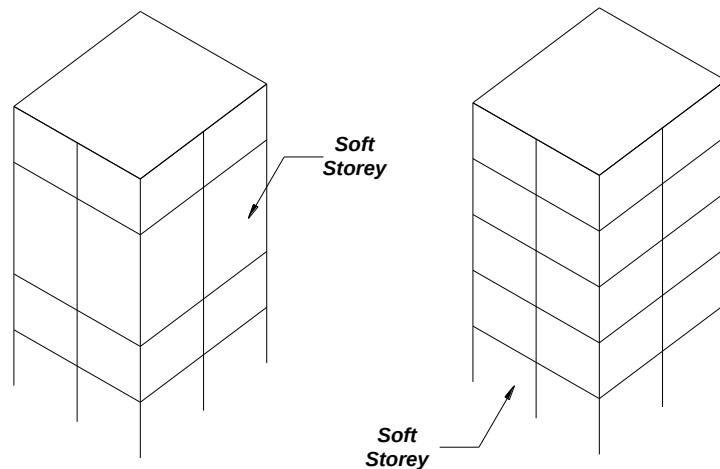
Perubahan Bentuk Struktur Bangunan Pada Arah Vertikal ⁽³⁾
